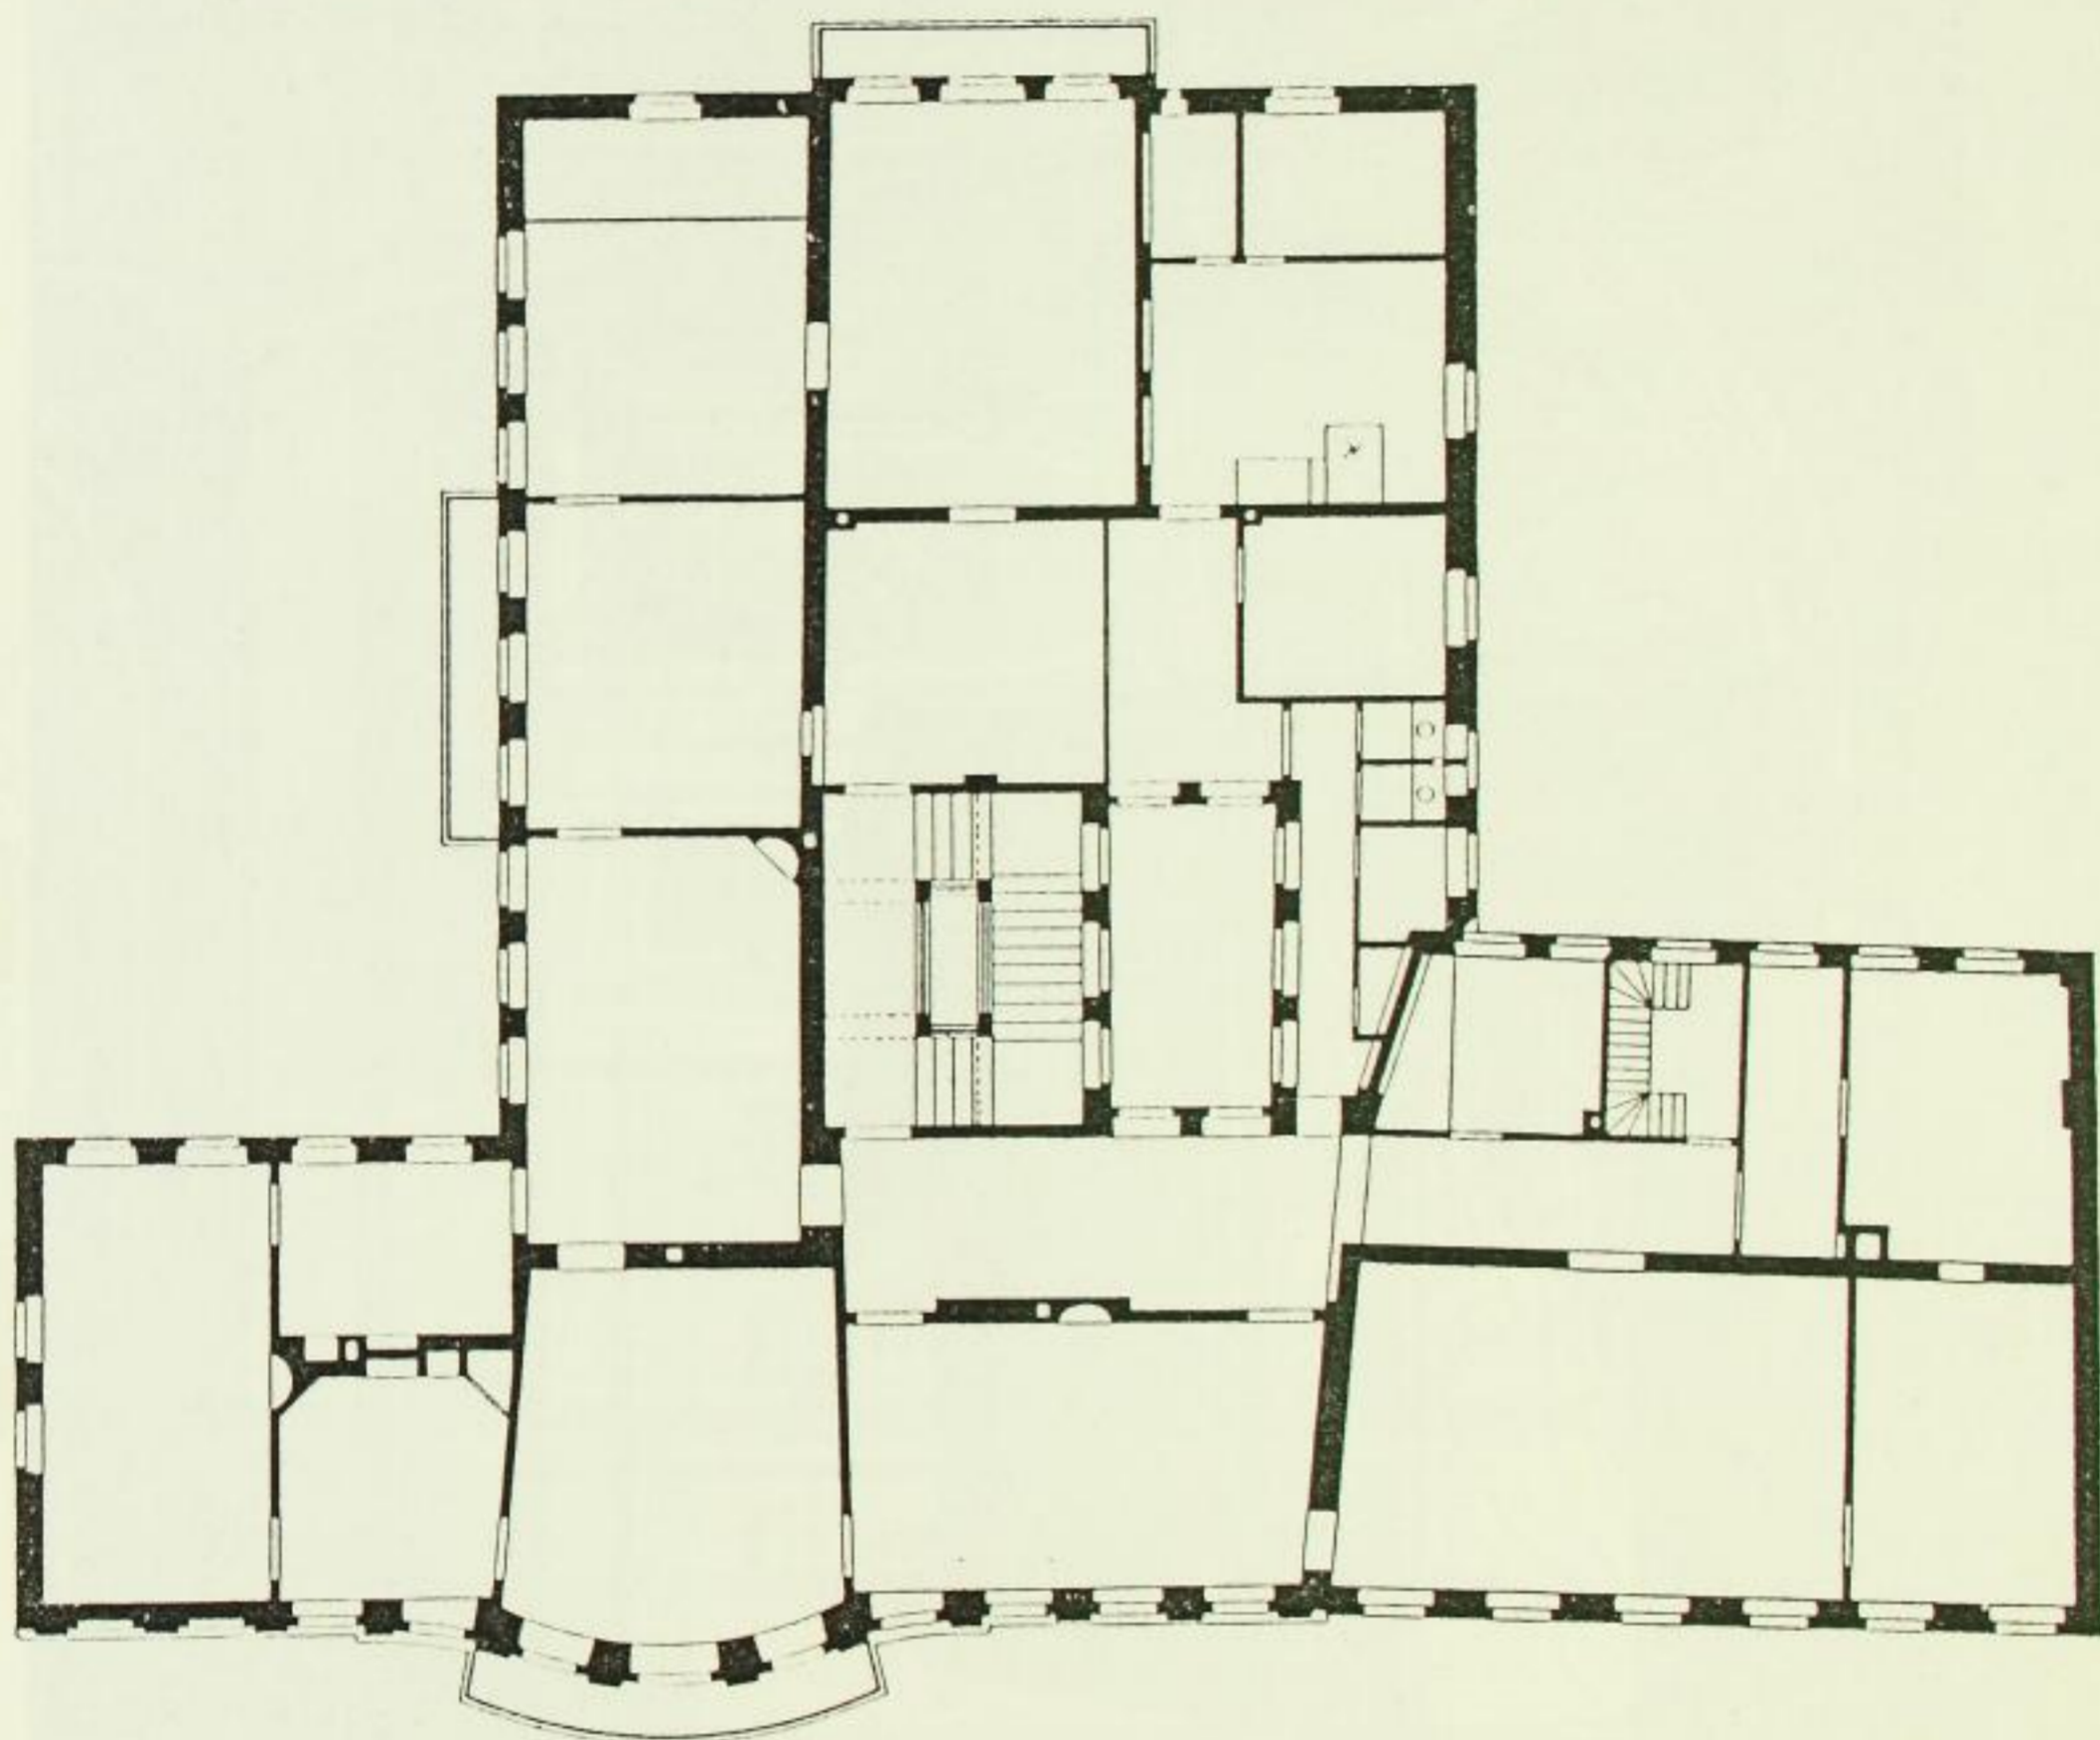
Boxberg'sches Palais, Grundriss des Obergeschosses.
